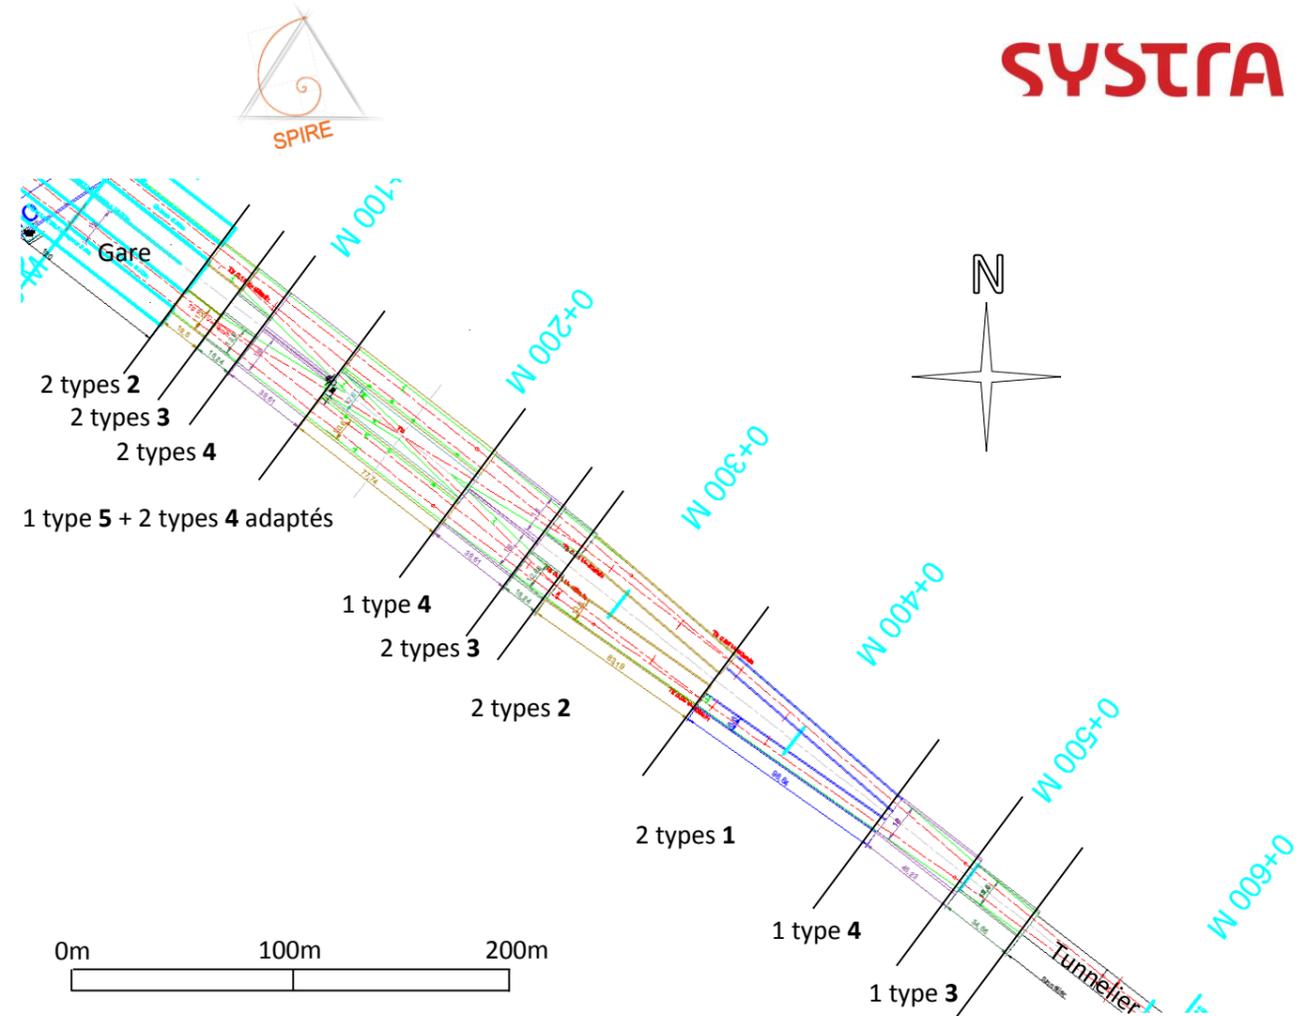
Vue en plan du génie civil des ouvrages de l'avant-gare Sud
